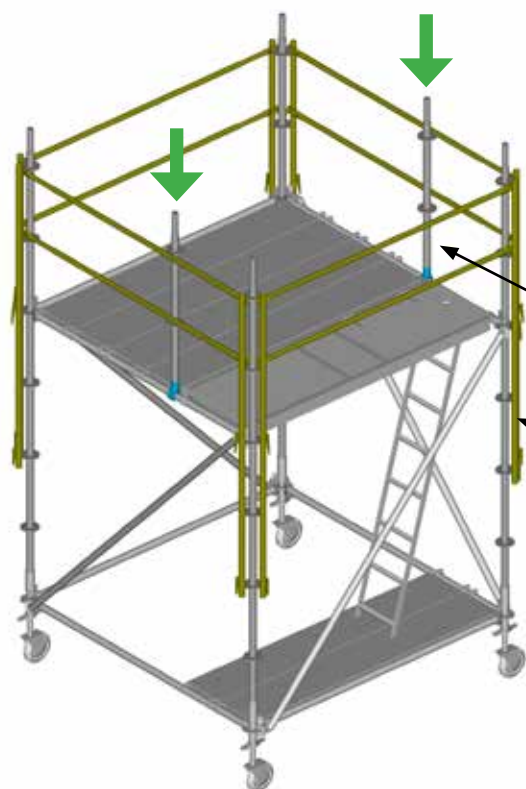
Planchers sur les lisses situées à une hauteur de 2 m par rapport aux éléments de départ. Palier d'échelle sur les planchers.
